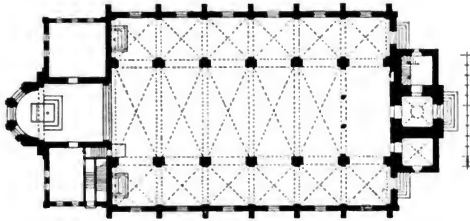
Grundriß der Kirche zu Bremerhaven.
